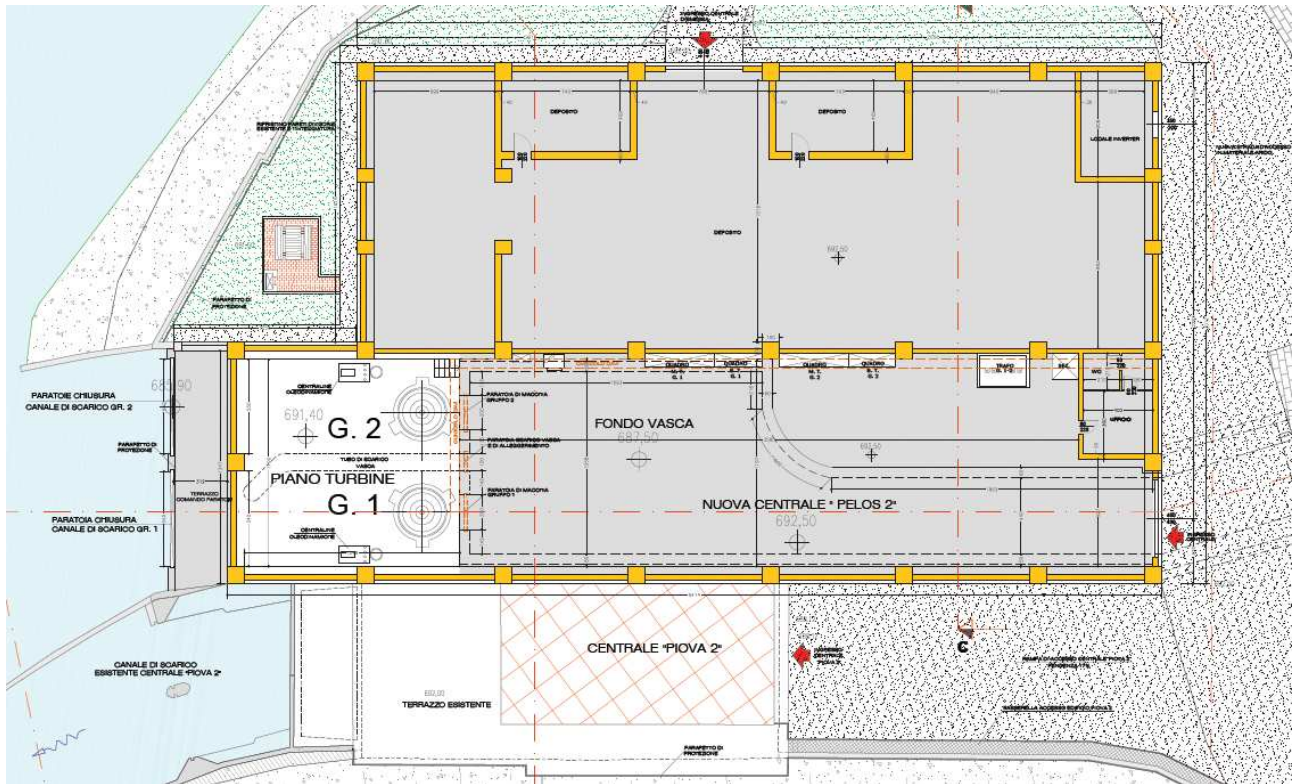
Estratto Tav. 9 - Pianta edificio centrale di produzione
